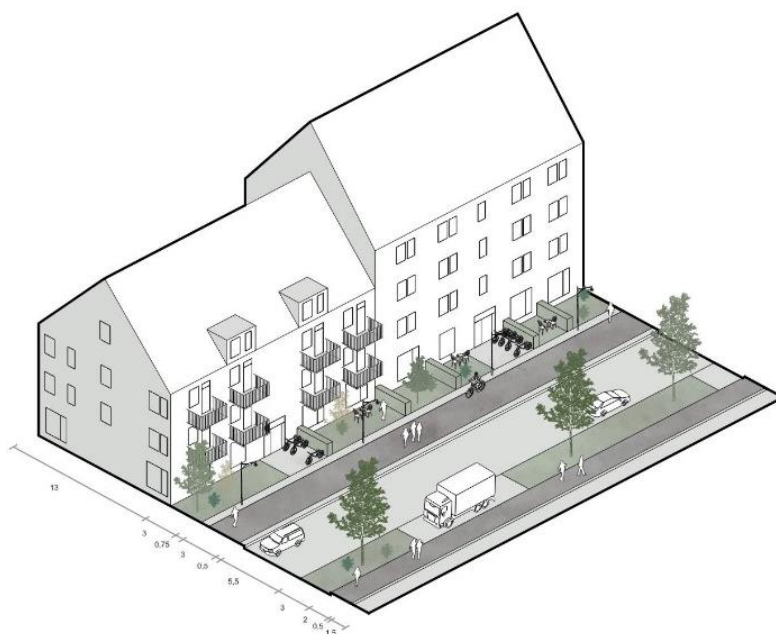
Illustrationsplan för planområdet (Bildkälla: Krook & Tjäder).
